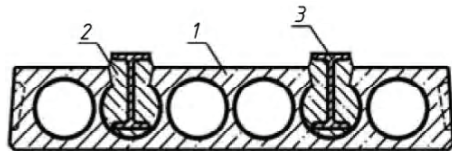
Подведение металлических разгружающих балок сверху: 1 – усиливаемая плита; 2 – монолитный бетон; 3 – разгружающая балка.
